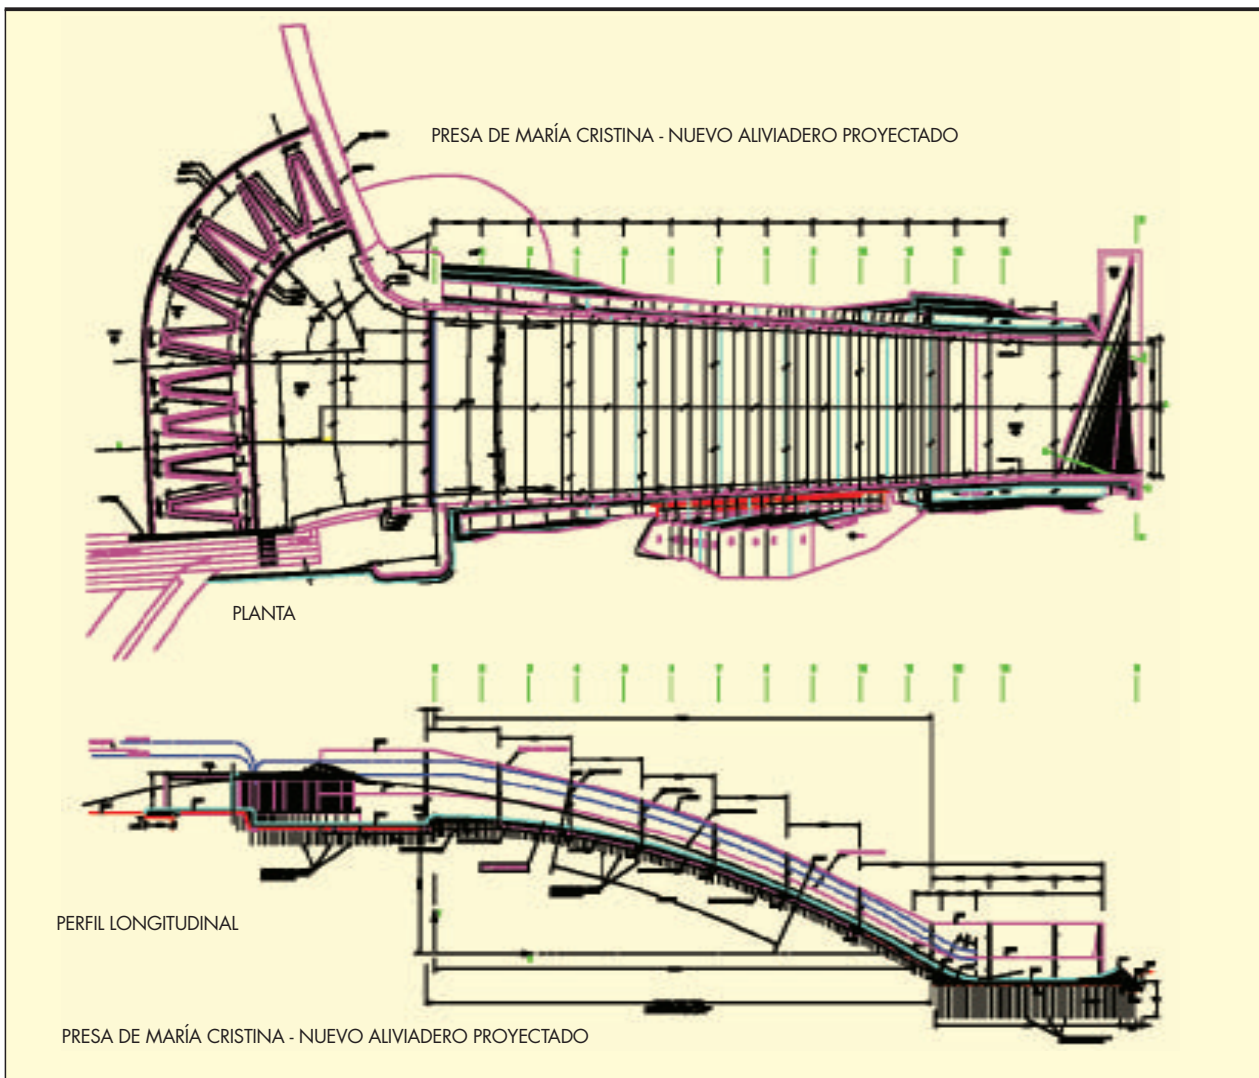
Planta y perfil longitudinal laberinto de 9 módulos.
